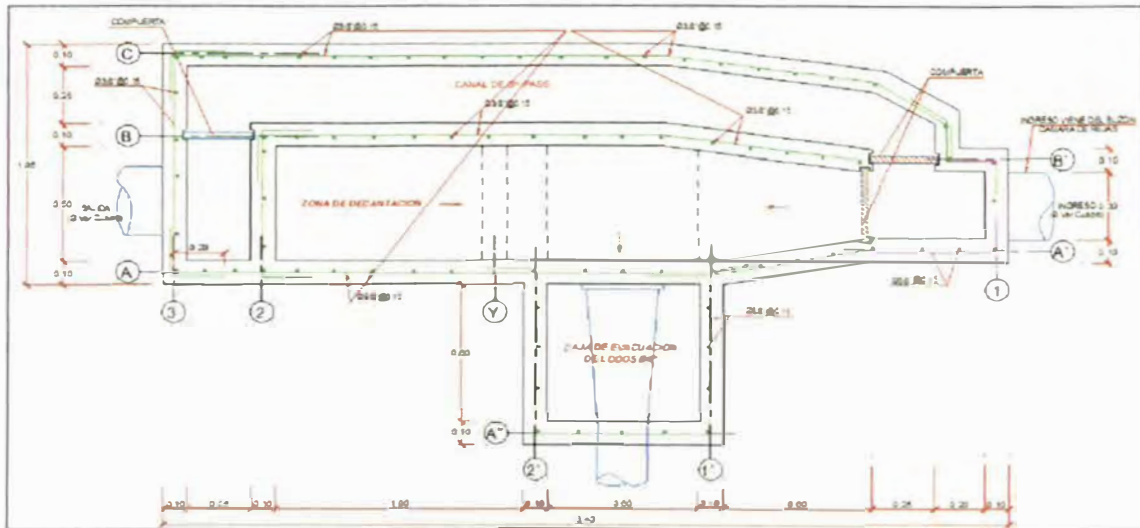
Vista en planta del Desarenador de la PTAR
